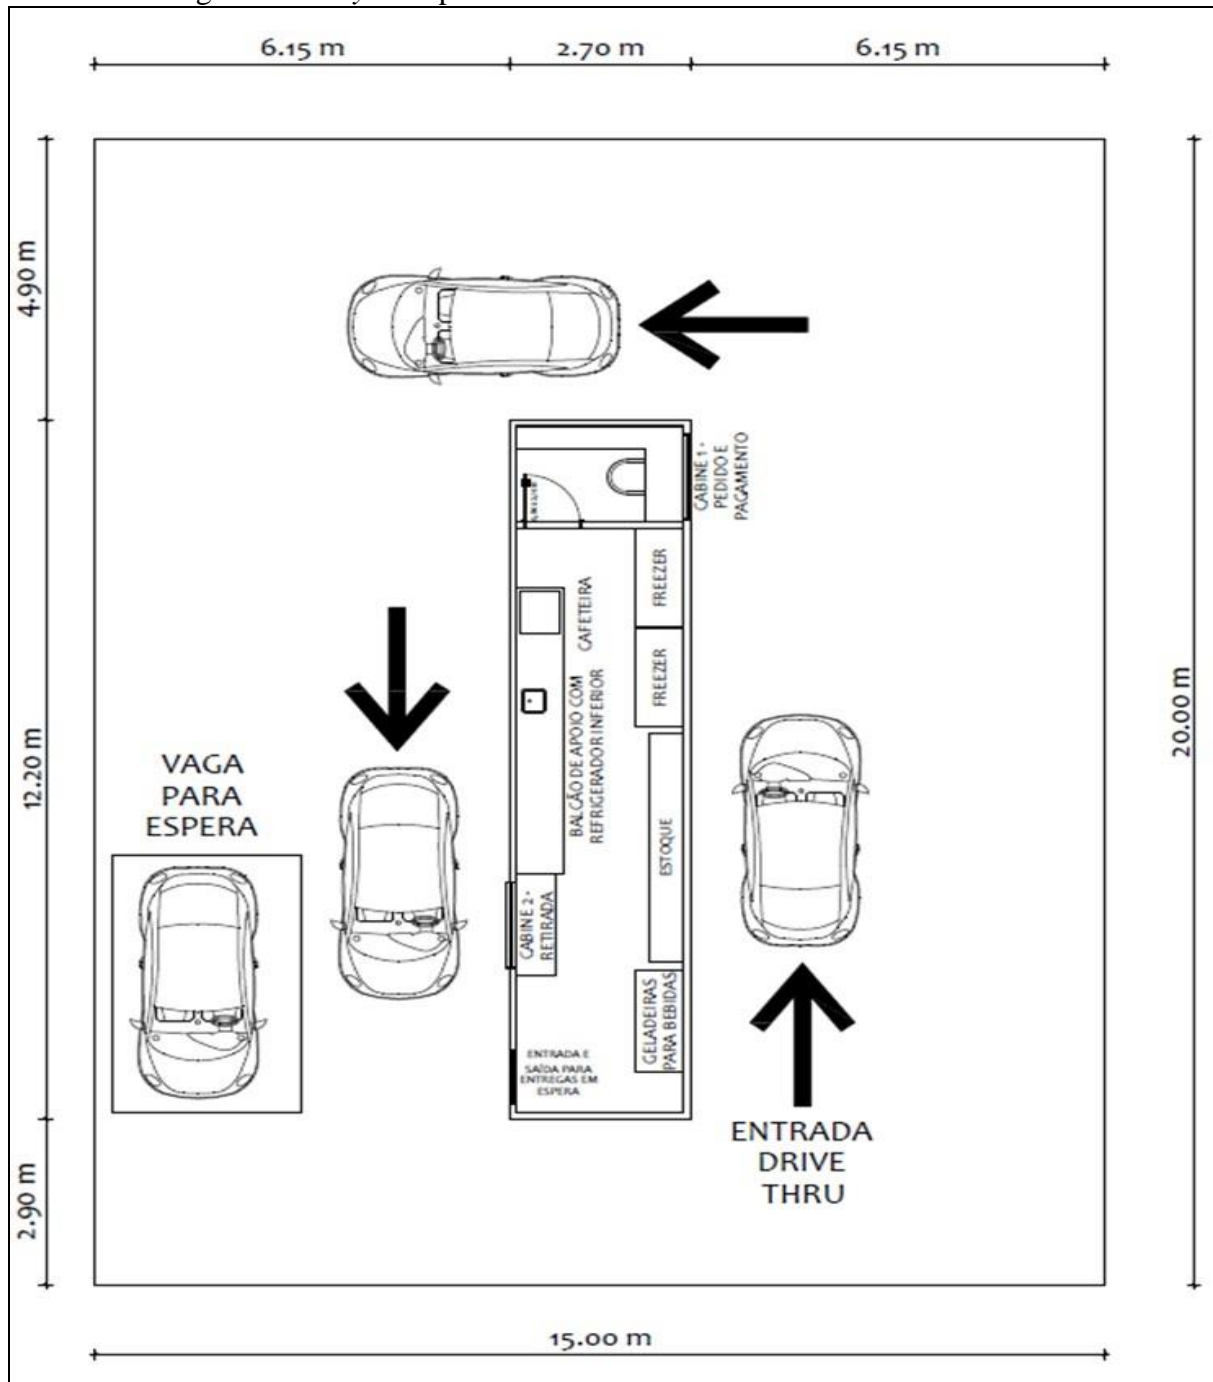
Layout* e planta baixa do sistema *drive thru* no local existente
